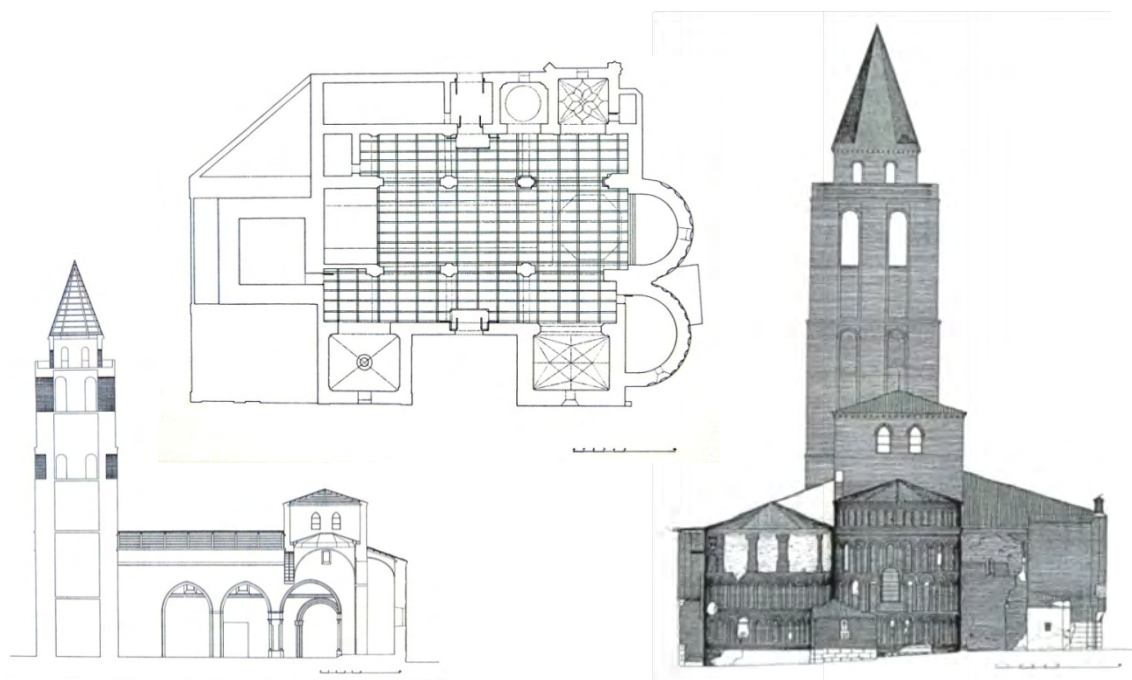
planta, sección y alzado de iglesia parroquial de San Nicolás en Madrigal de las Altas Torres por Juan José Conde Muñoz. 2002.
